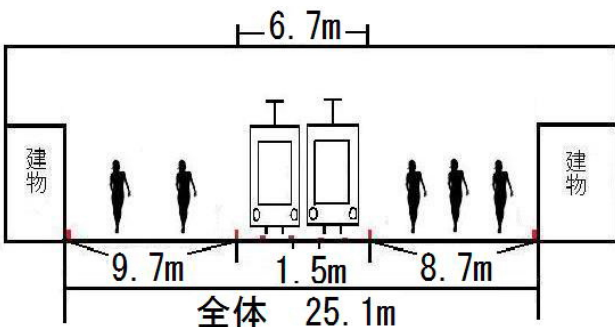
ロンシャン通り(マルセイユ, 仏)の断面図
